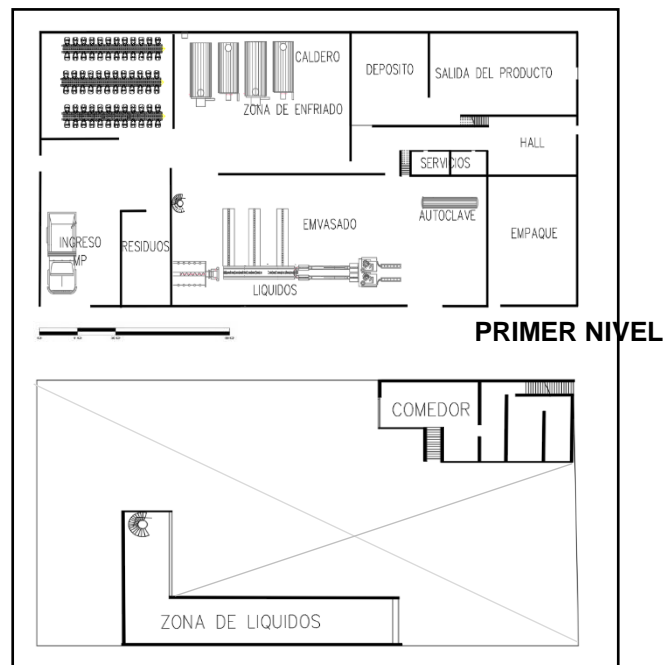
PLAN O ESQUEMÁTICO FABRICA OLDIM
